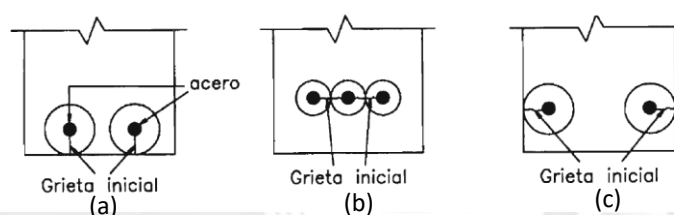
FALLA DE ADHERENCIA ENTRE CONCRETO Y ACERO.
